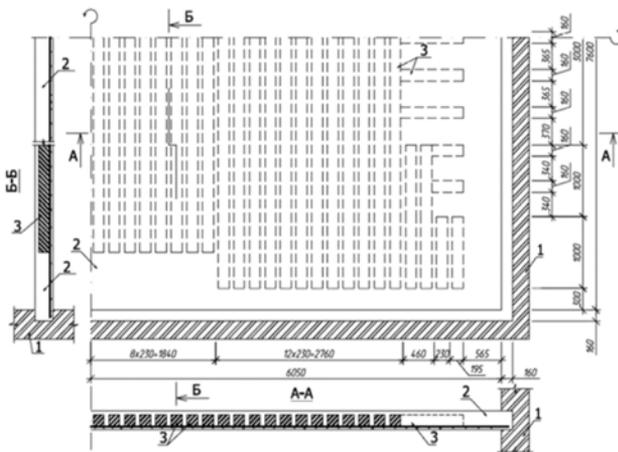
Общее конструктивное решение перекрытия: 1 – каменные стены; 2 – монолитный железобетон; 3 – вставки из пенопласта
